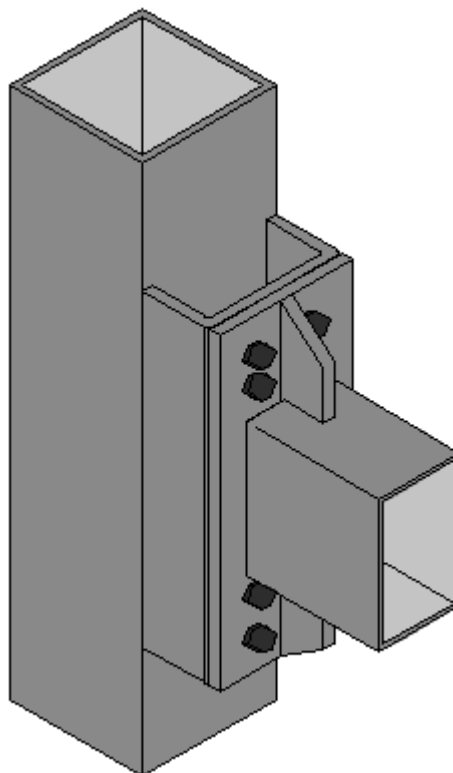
Ligação viga-pilar com “reverse channel”
